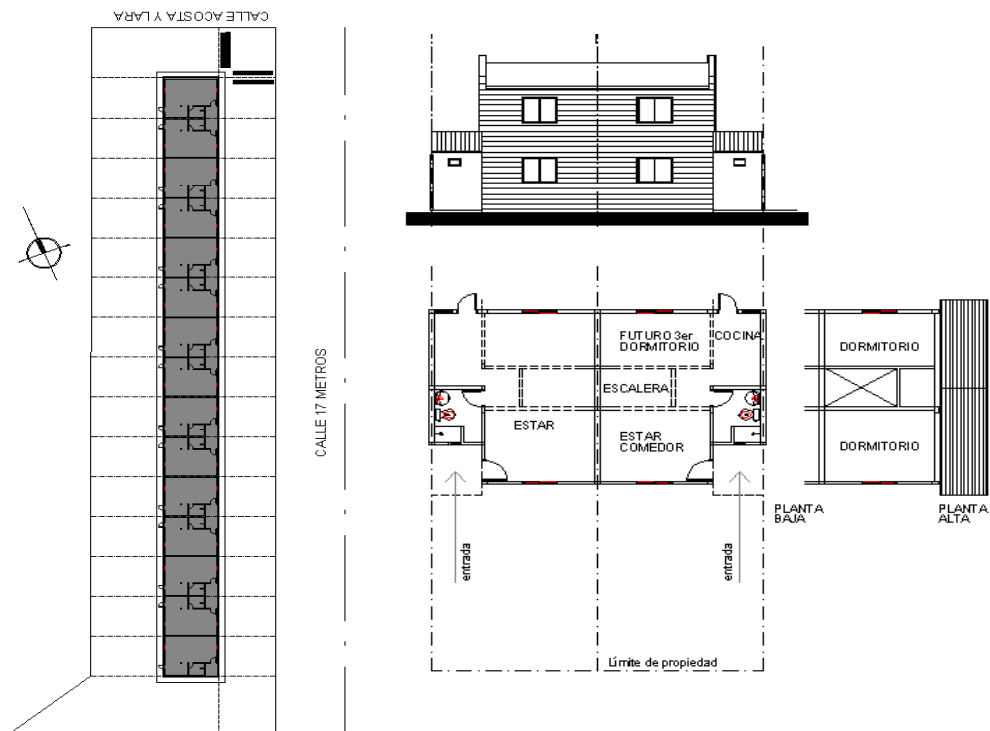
Complejo habitacional sobre calles Acosta y Lara y Santa Mónica planta de ubicación, planta y alzado de la casa suministrados por el Servicio de Tierras y Viviendas de la IMM en el año 2006. Fotos del mismo barrio, de la autora, año 2006- 2007.
